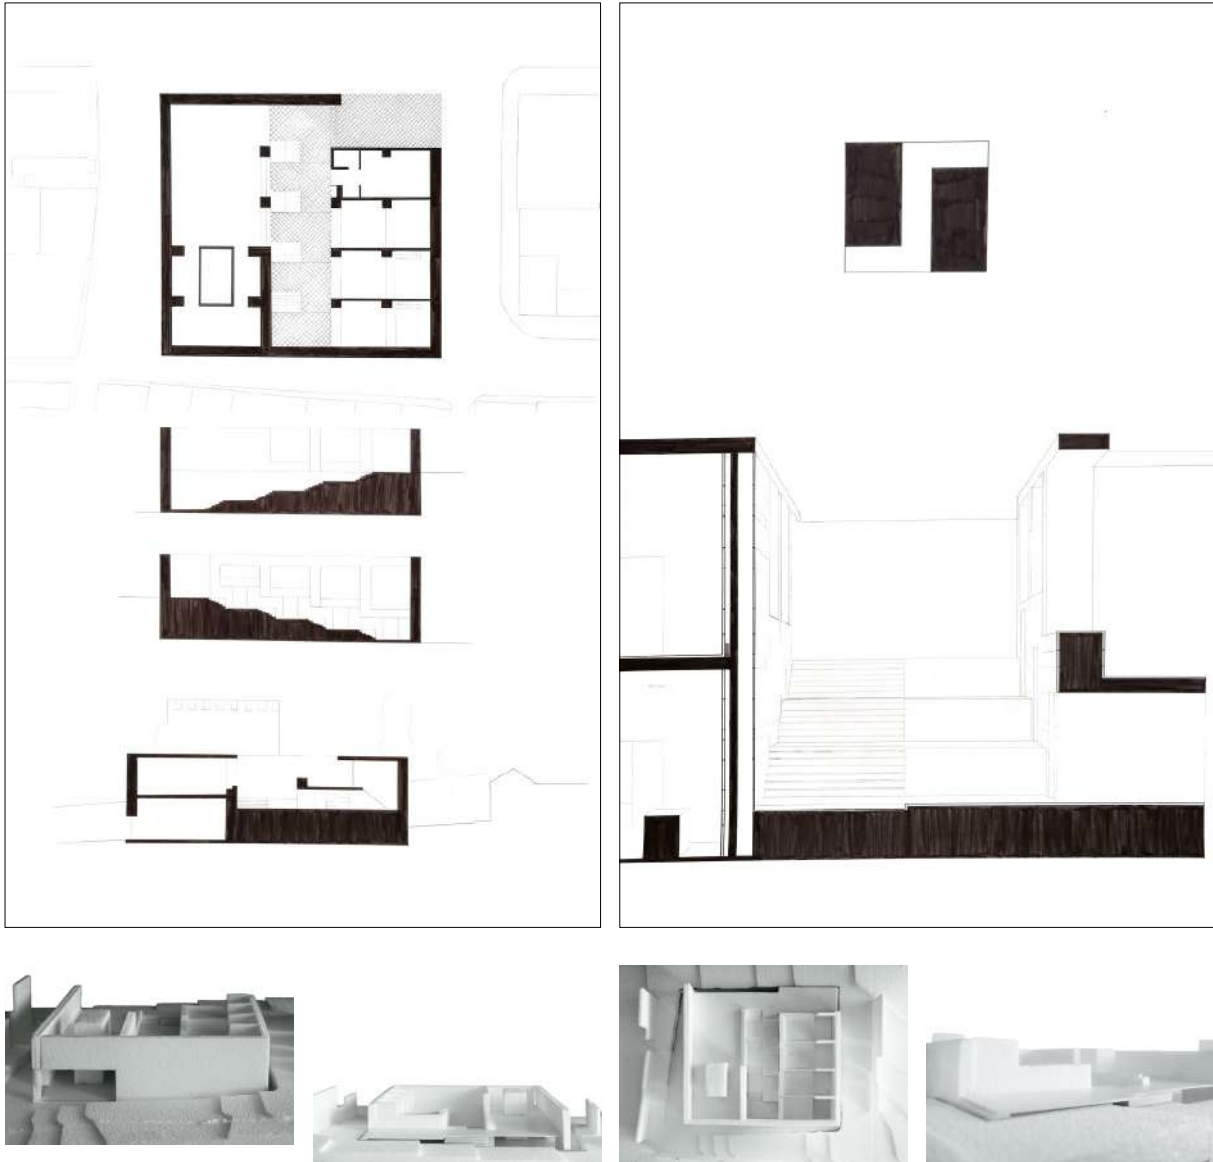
Digitalização de painel A1 composto por planta e cortes à escala 1:100.
